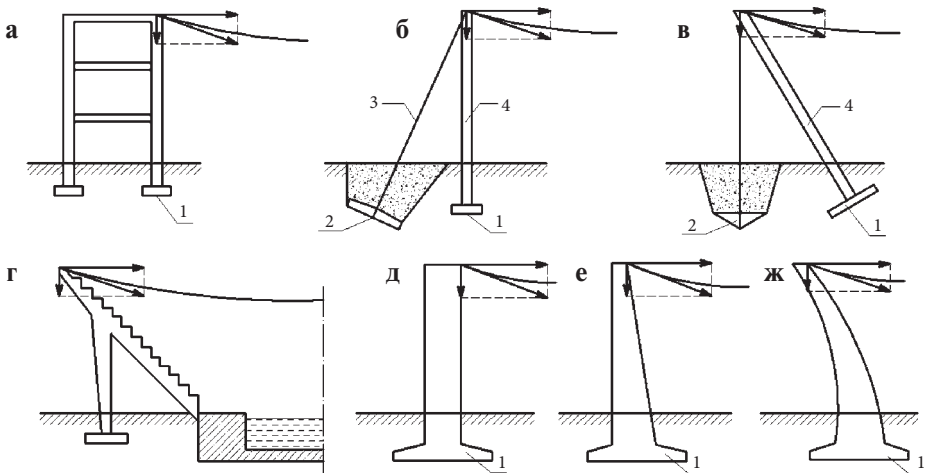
Схемы опорных конструкций висячих покрытий при разомкнутом наружном контуре: а) жесткая рама; б) подкосная система с наклонной оттяжкой; в) подкосная система с вертикальной оттяжкой; г) трибуна; д, е, ж) пилоны; 1 — фундамент; 2 — анкерный фундамент; 3 — оттяжка; 4 — стойка
